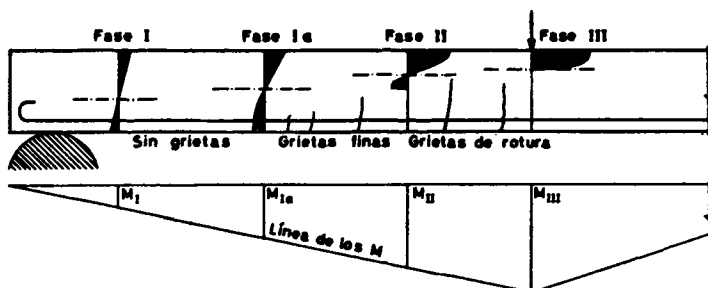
Estados de tensión en diversas secciones de una viga cargada hasta la rotura.¹⁶
